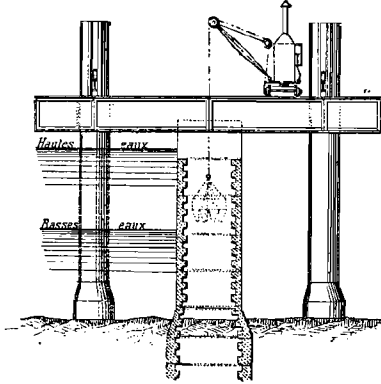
Vue de profil de la plate-forme servant à la construction des piles.
